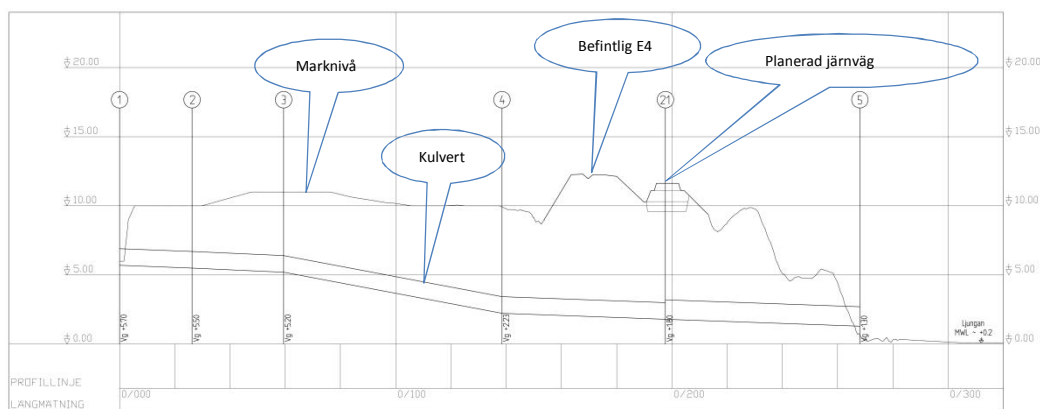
Kulvert Tingstagärdesbäcken
